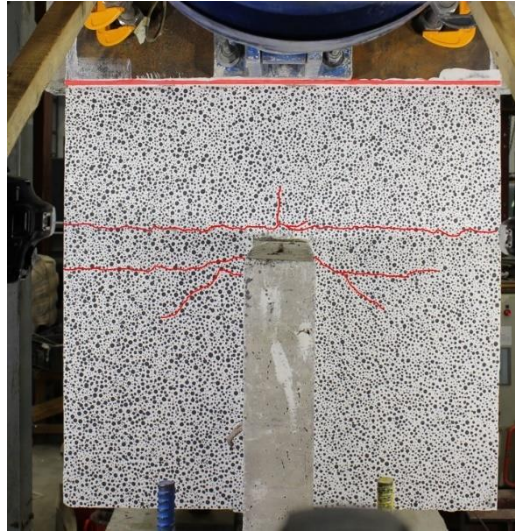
Primeras grietas a una rotación de 0.037 [rad].
